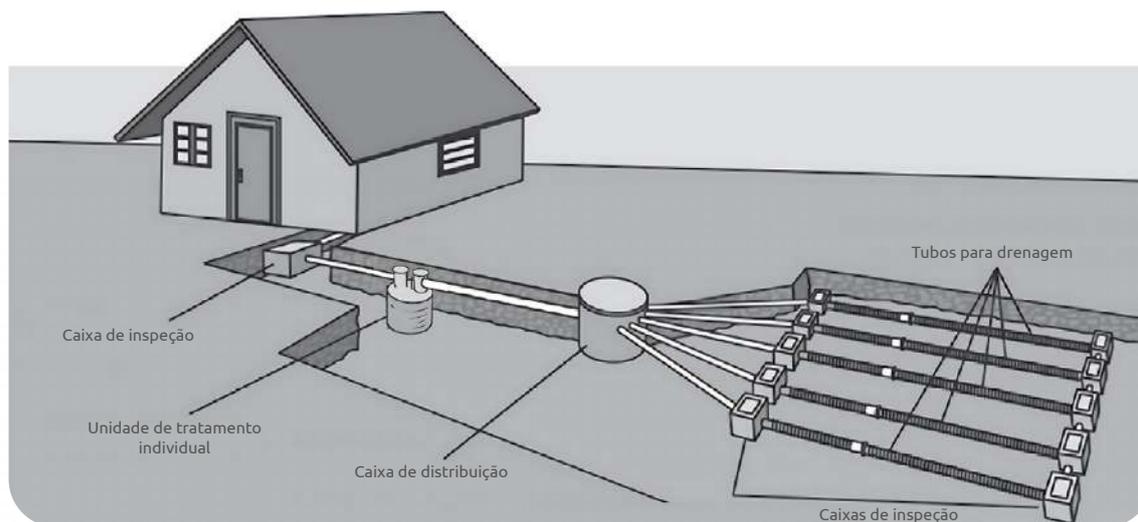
Esquema de instalação da UNIFAM com sistema de infiltração
